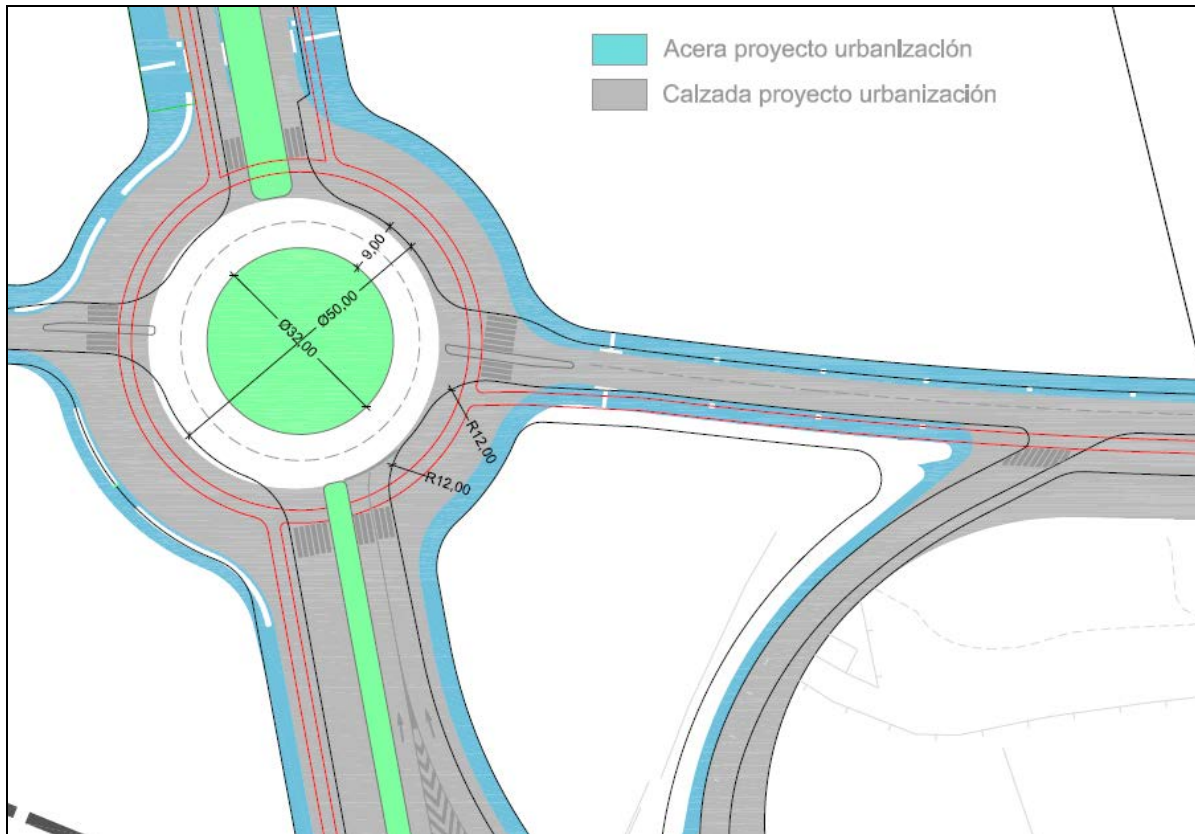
Propuesta para la rotonda Sur de Tamaraceite
